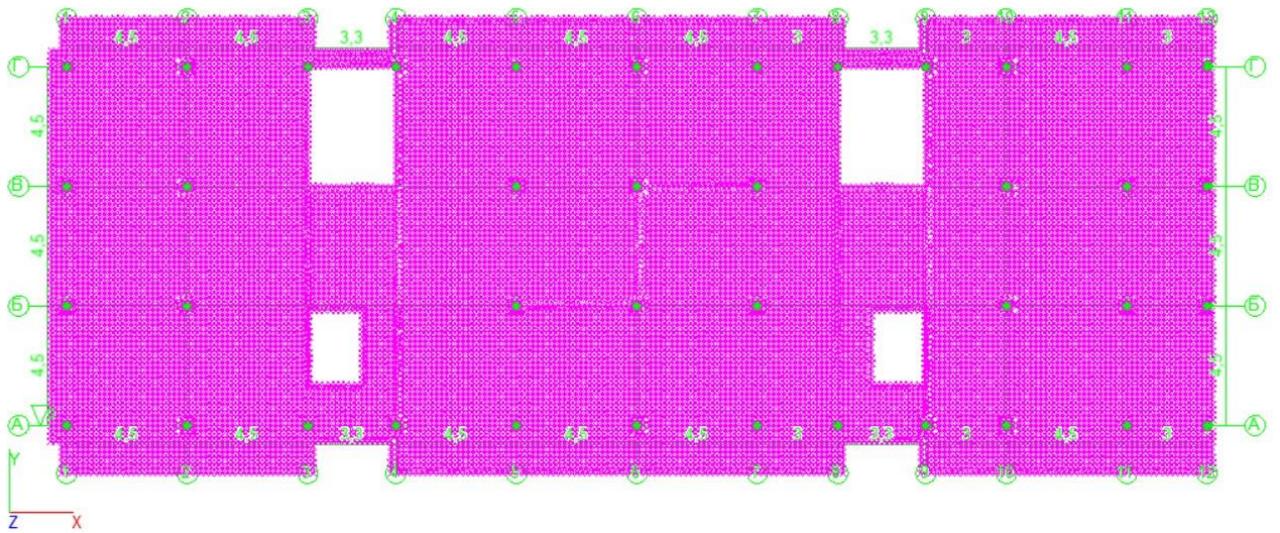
Общий вид постоянного нагружения перекрытия от собственного веса плиты и конструкций пола
